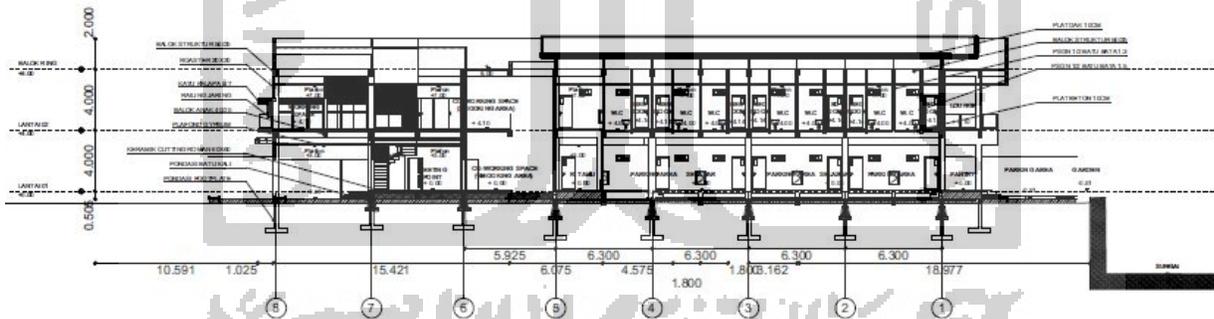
Denah Proyek Co-working dan Boarding House Eksklusif
